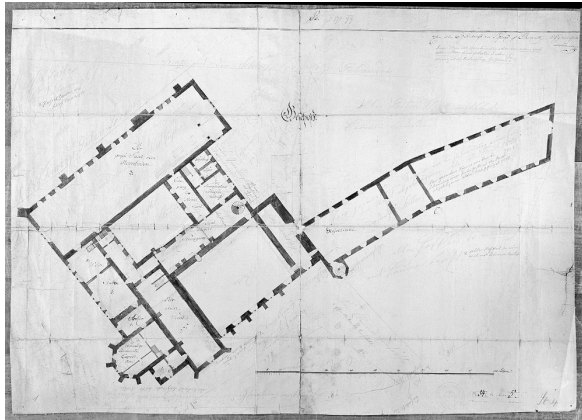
Grundriss des Schlosses Chemnitz, Obergeschoss mit handschriftlicher Bezeichnung des Geißelsaales, lavierte Federzeichnung, 48 x 67,5 cm, um 1800.
